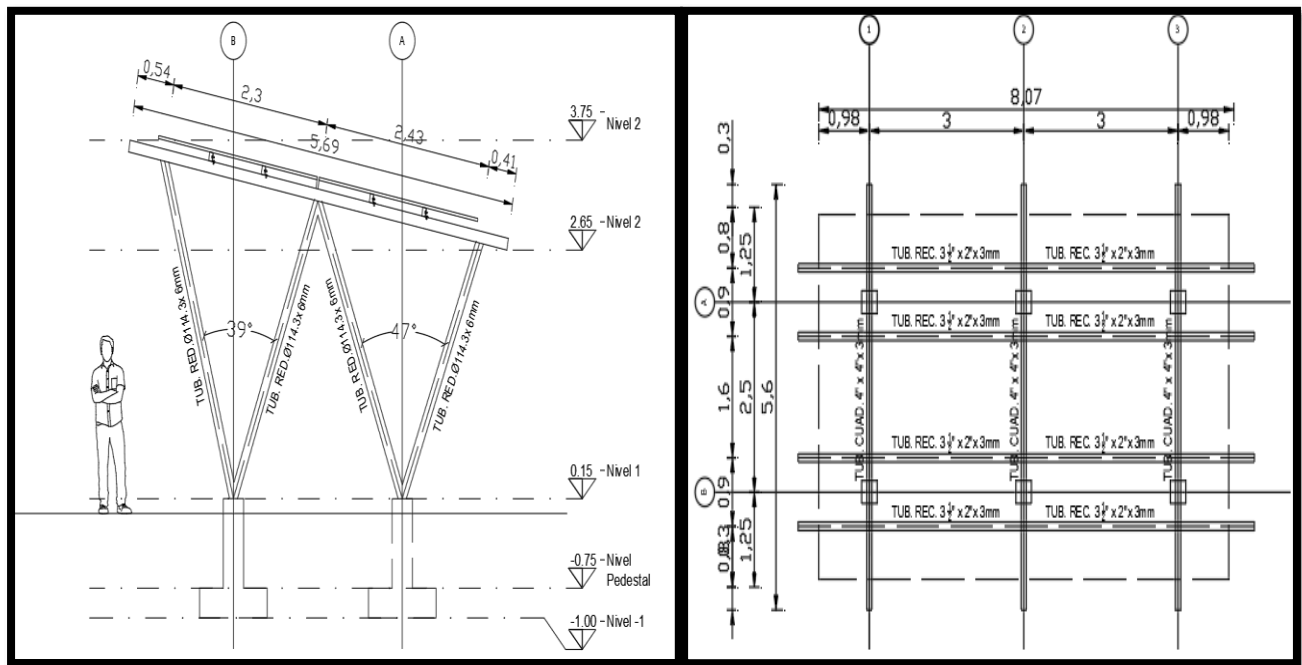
Estructura metálica para soporte de módulos fotovoltaicos.
